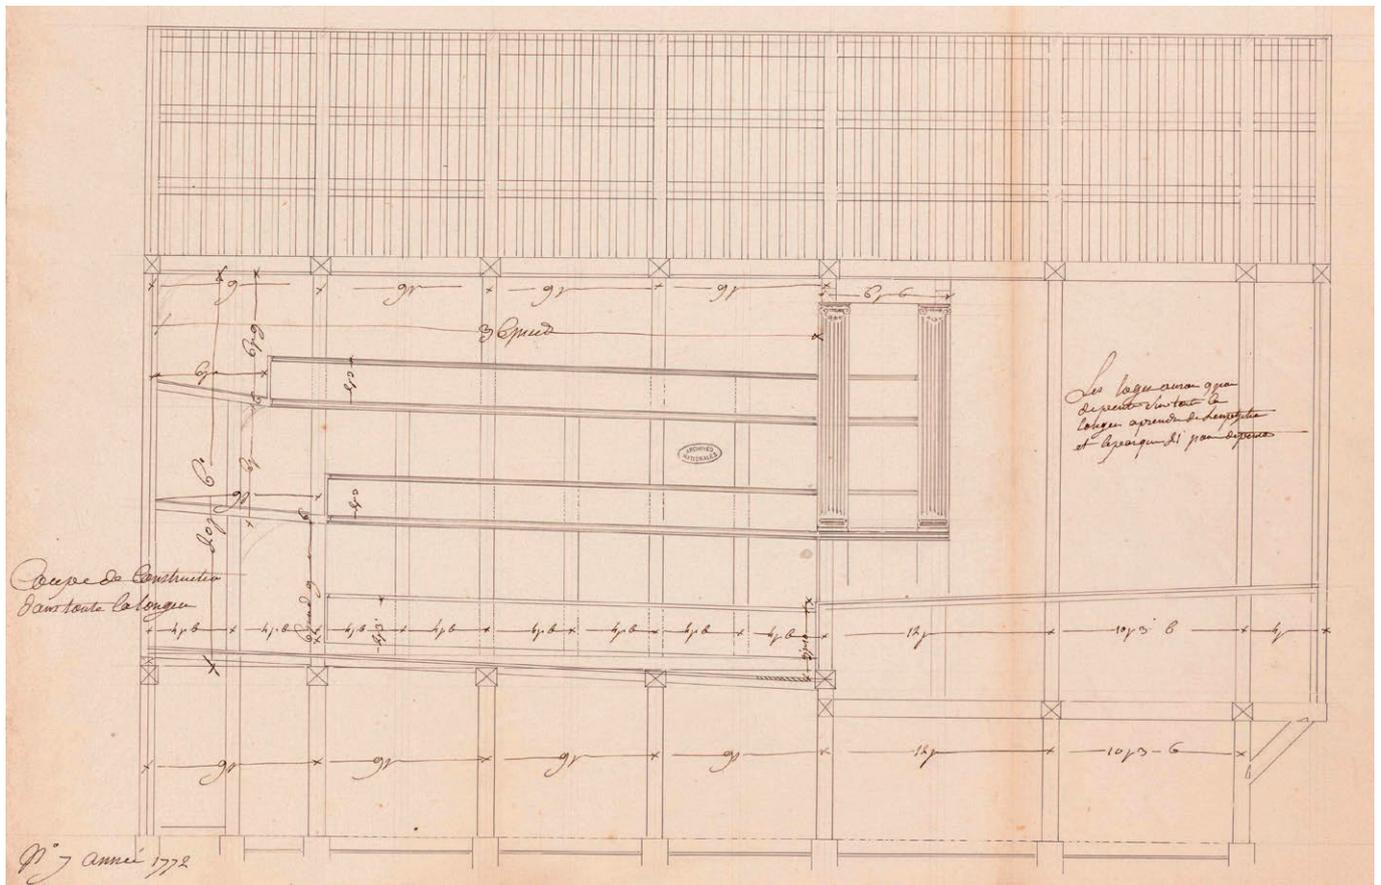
Planche A.N. N/III/Seine/1030FSG/40, montrant la coupe longitudinale du projet FSG-APD, où l'on voit que la salle est disposée au-dessus du rez-de-chaussée.
